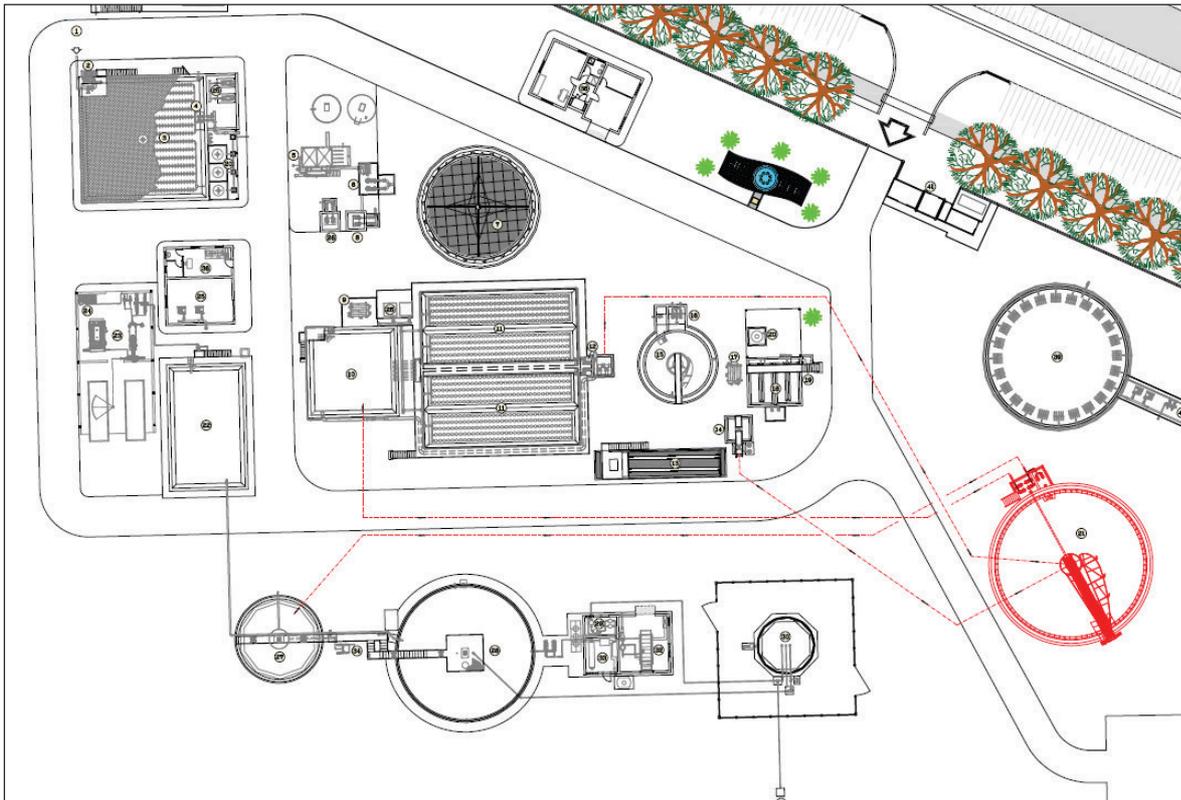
Dettaglio dell'ipotesi b): realizzazione di un nuovo sedimentatore circolare
